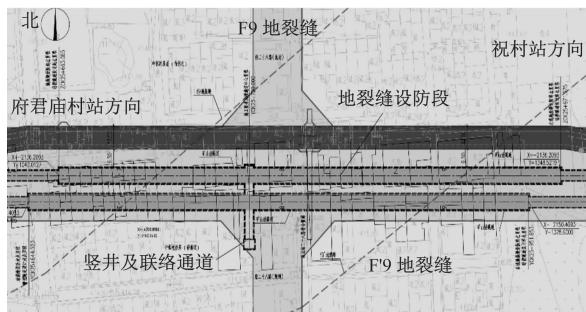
西安地铁15号线府祝区间地裂缝设防段平面图
